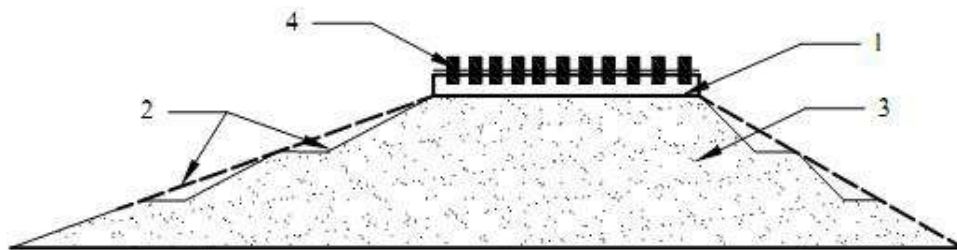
Перемещение грунта с высевкой, золой и цементом, доувлажнение грунтовой смеси до оптимальной влажности на гребне плотины: 1 – гребень; 2 – уступы; 3 – плотина; 4 – фреза
